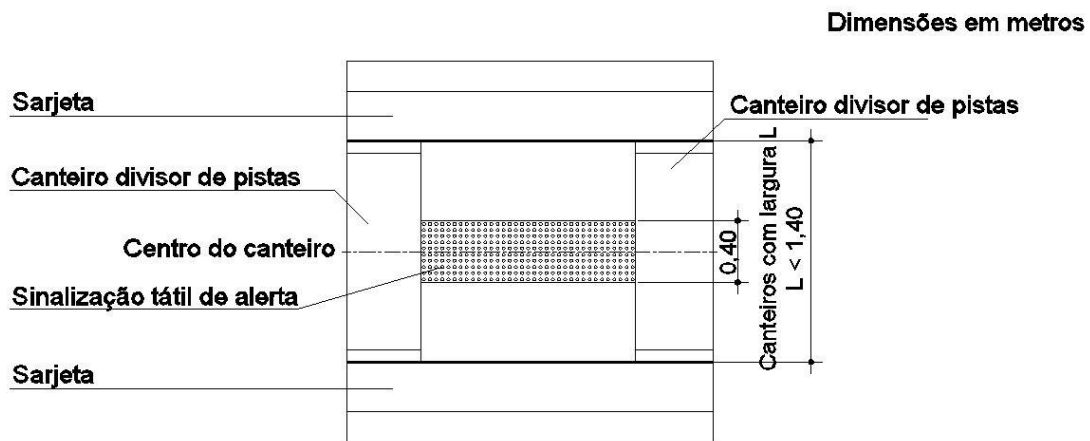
Rebaixamento de canteiro divisor de pistas $L < 1,40$ m
